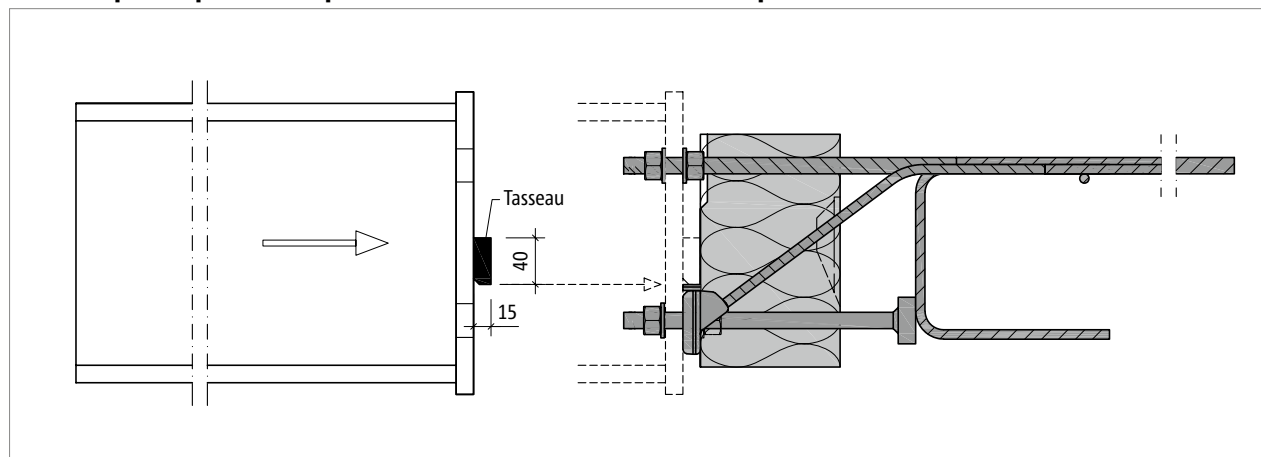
Schöck Isokorb® XT type SK : montage de la poutre en acier
